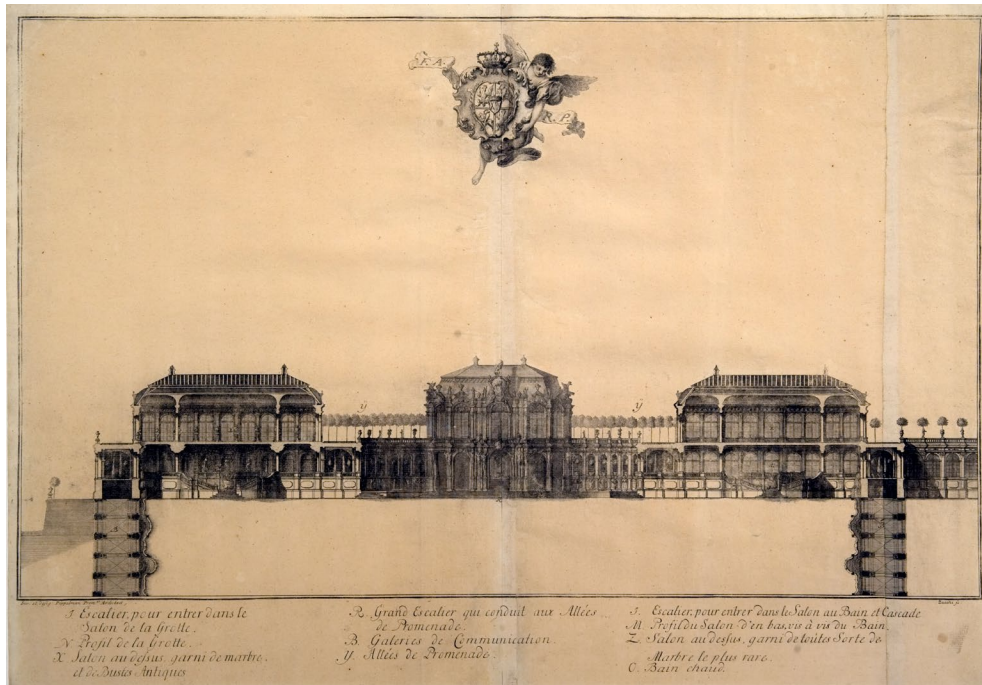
Andrea Zucchi nach Matthäus Daniel Pöppelmann, Schnitt durch die Orangerie am Wall des Dresdner Zwingers mit Teilgrundrissen der existenten (li.) und der geplanten (re.) Langgalerie, rechts im Aufriss ergänzt um eine projektierte Erweiterung in Richtung Elbe, Radierung, Tafel aus dem Zwingerstichwerk (Pöppelmann 1729).
